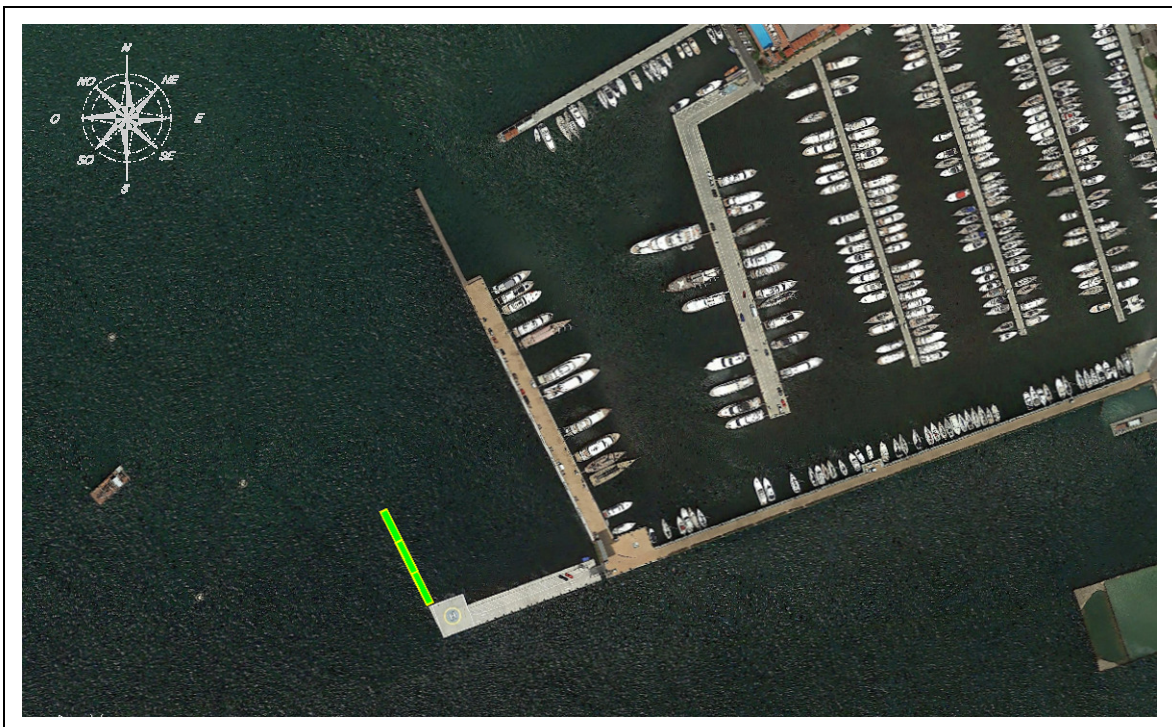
Layout della prevista espansione di Porto Lotti nella fase 1
